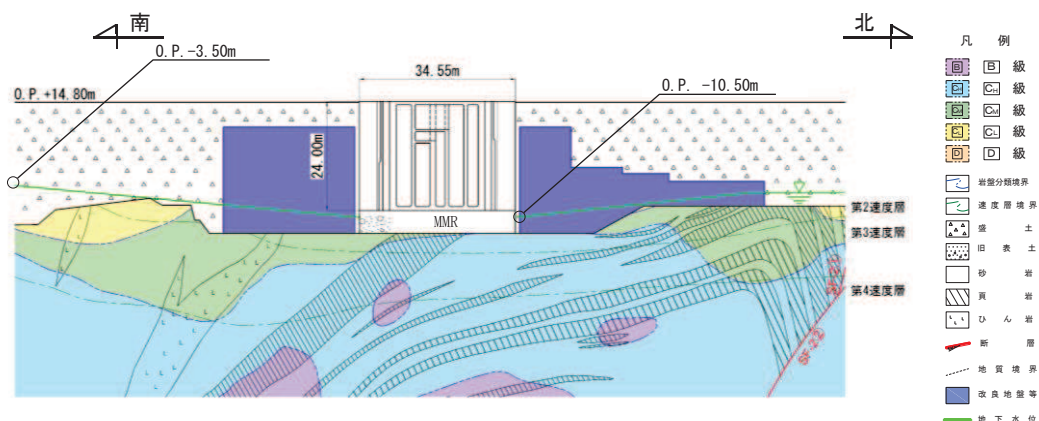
地盤改良範囲（盛土部縦断面図，② - ②断面）
